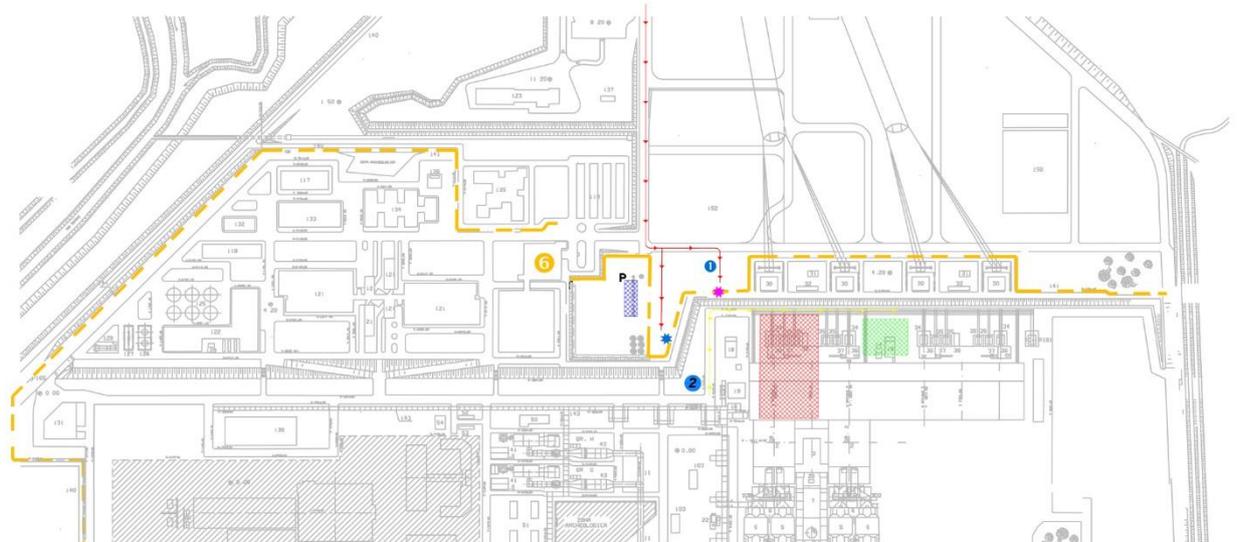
Estratto Planimetria di Progetto. In rosso l'area del compensatore e in verde l'area di cantiere.
